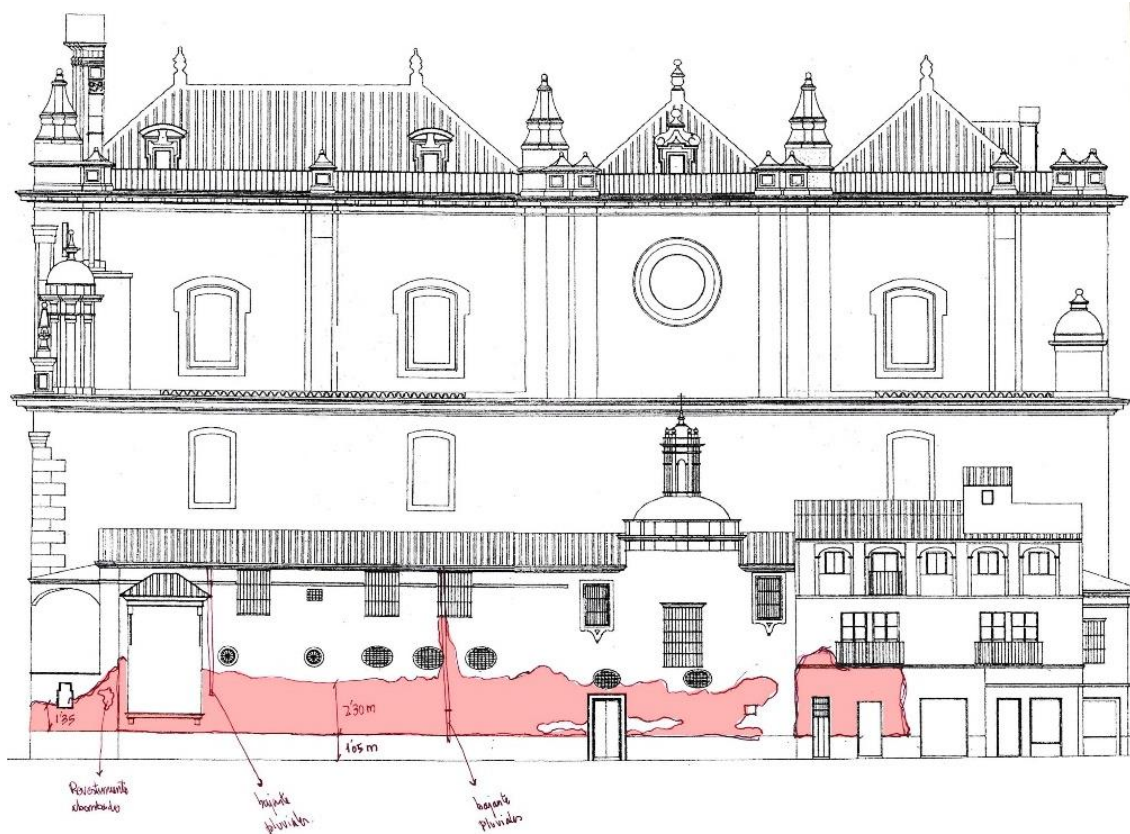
Levantamiento de Humedades. Fachada Sur. Estado actual
